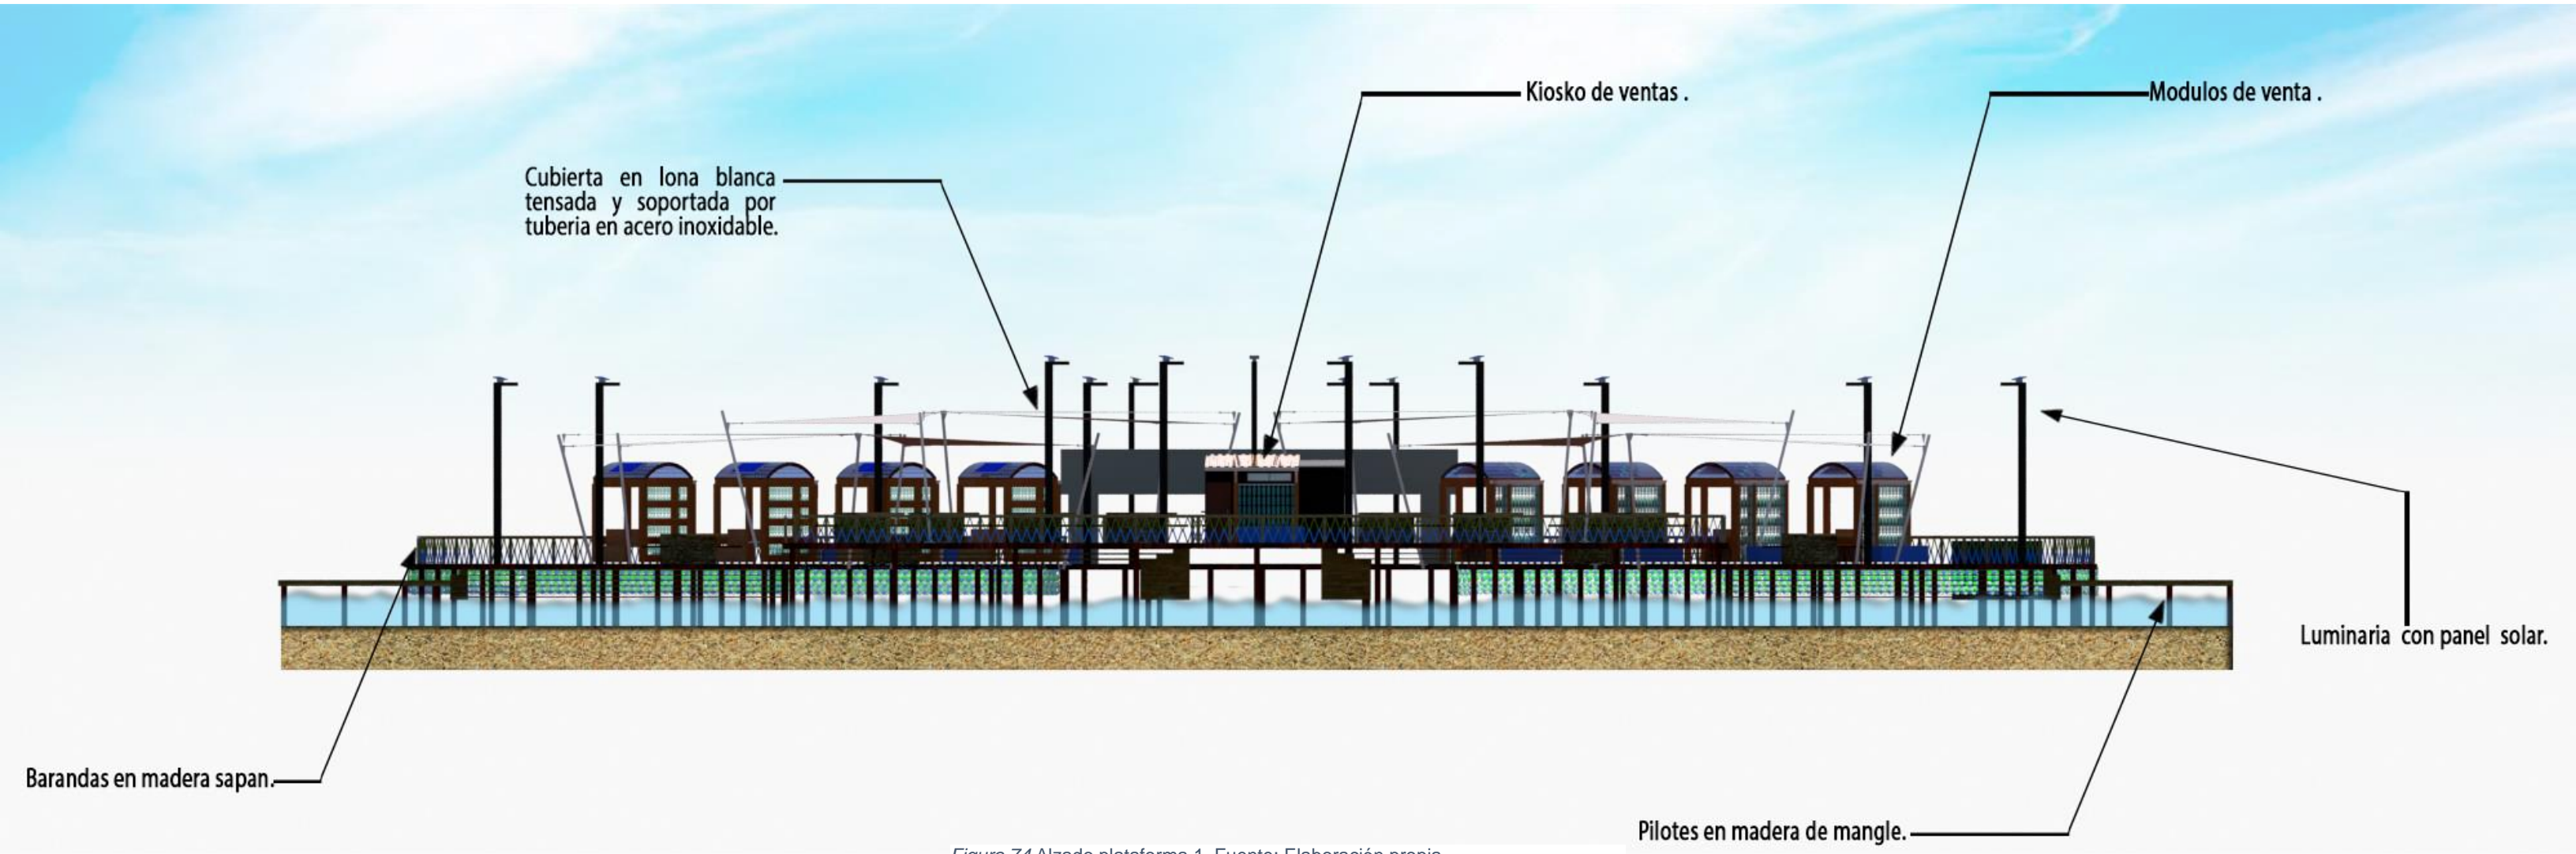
Alzado plataforma 1. Fuente: Elaboración propia
